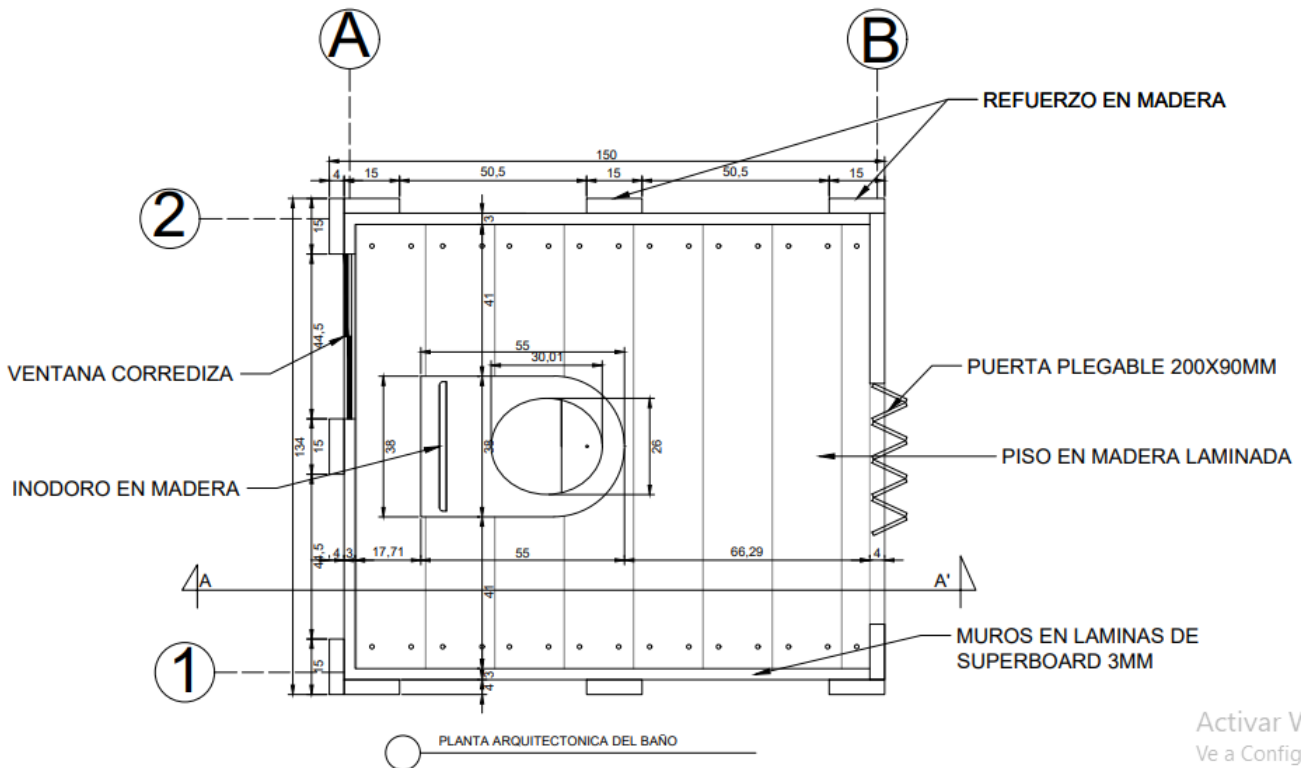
Diseño de la planta arquitectónica del baño seco. Elaboración propia en AutoCAD
